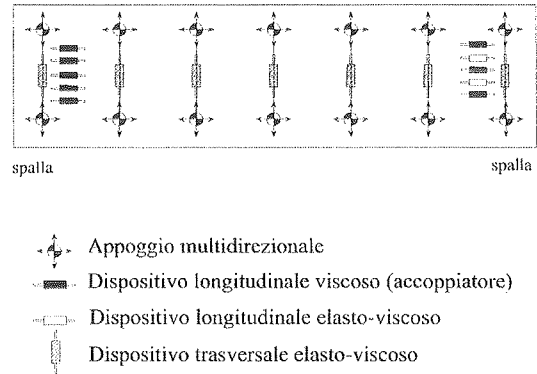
Schema planimetrico dei vincoli nel progetto di adeguamento per viadotto con pile basse
